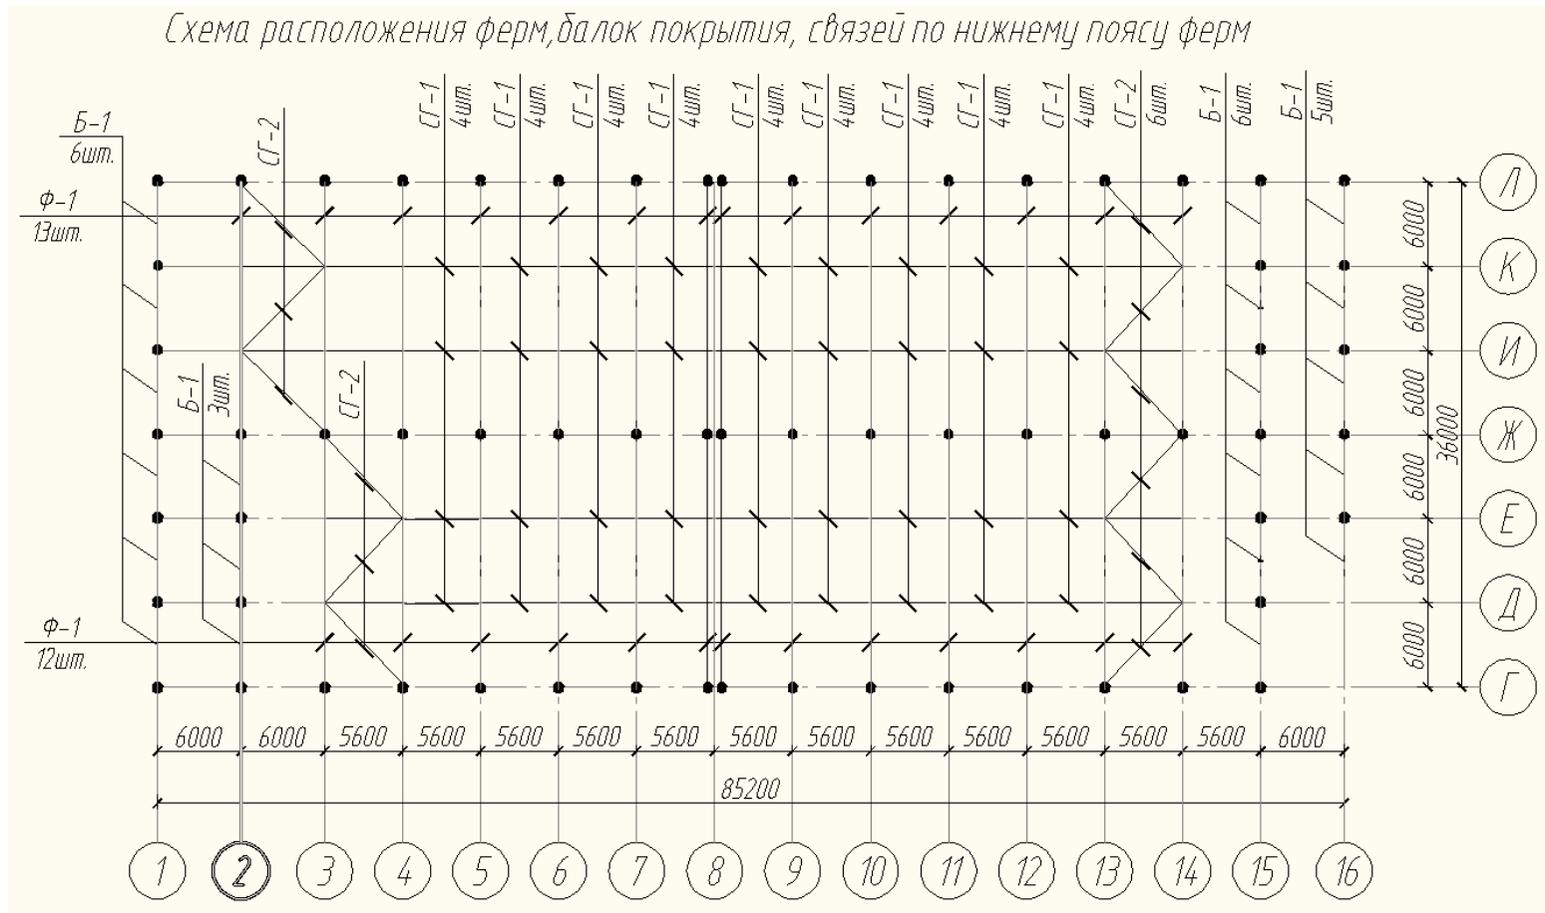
Схема расположения ферм, балок покрытия, связей по нижним поясам стропильных ферм
